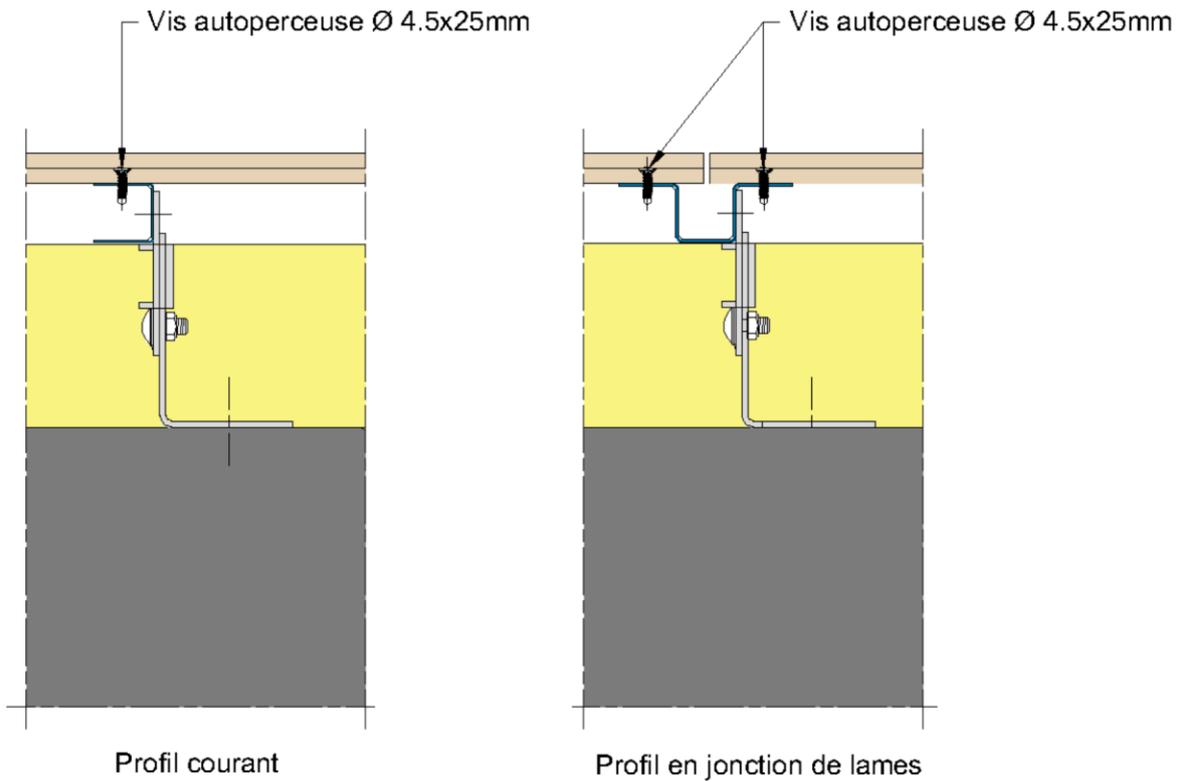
Pose sur ossature métallique – Fixation rive haute de la lame CEDRAL LAP pose horizontale
